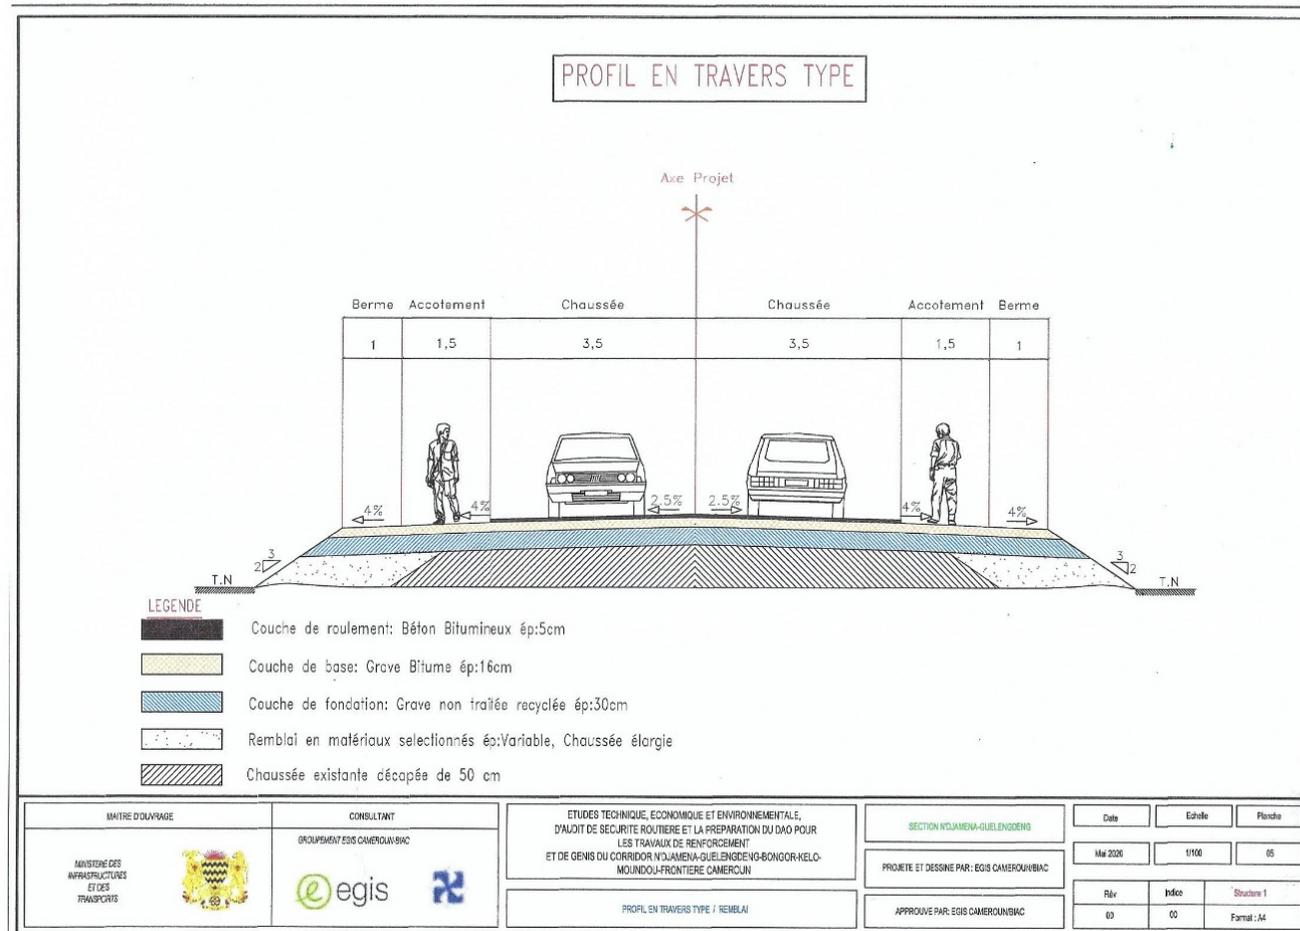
Profil en travers type 1x2 voies de la section Bongor-Kélo (Ham-Kélo), structure N°1
